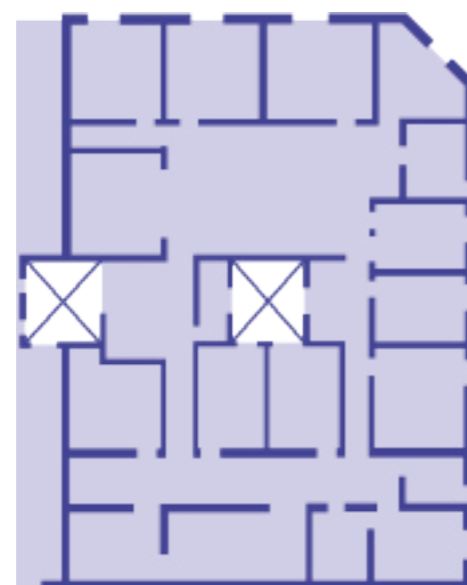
Análisis planimetría Portal Eliseo del Campo. Fuente: Elaboración propia.
